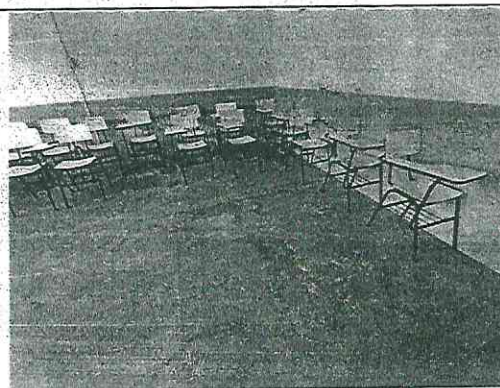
Salas localizadas no segundo andar com teto em madeira. Detalhe para a trinca vertical ao lado da parede.
